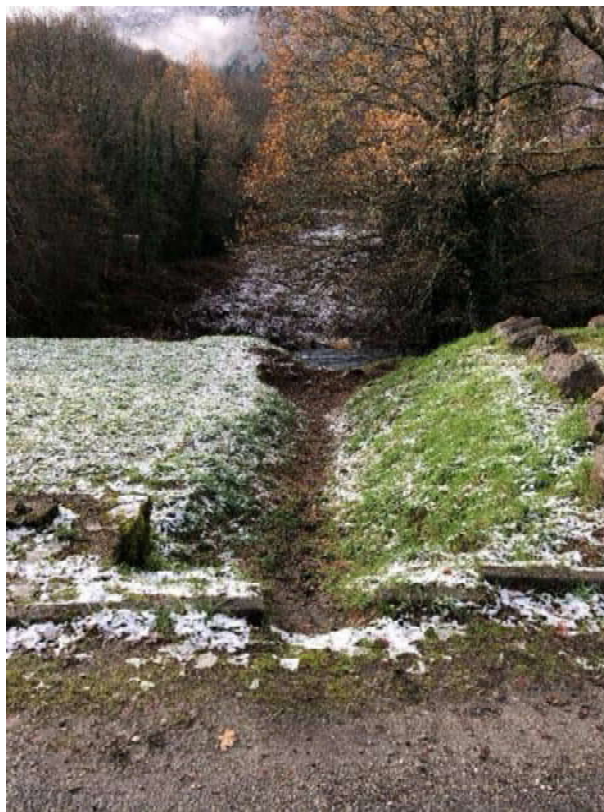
Merlon de terre réalisé par les sapeurs-pompiers lors de l'intervention
